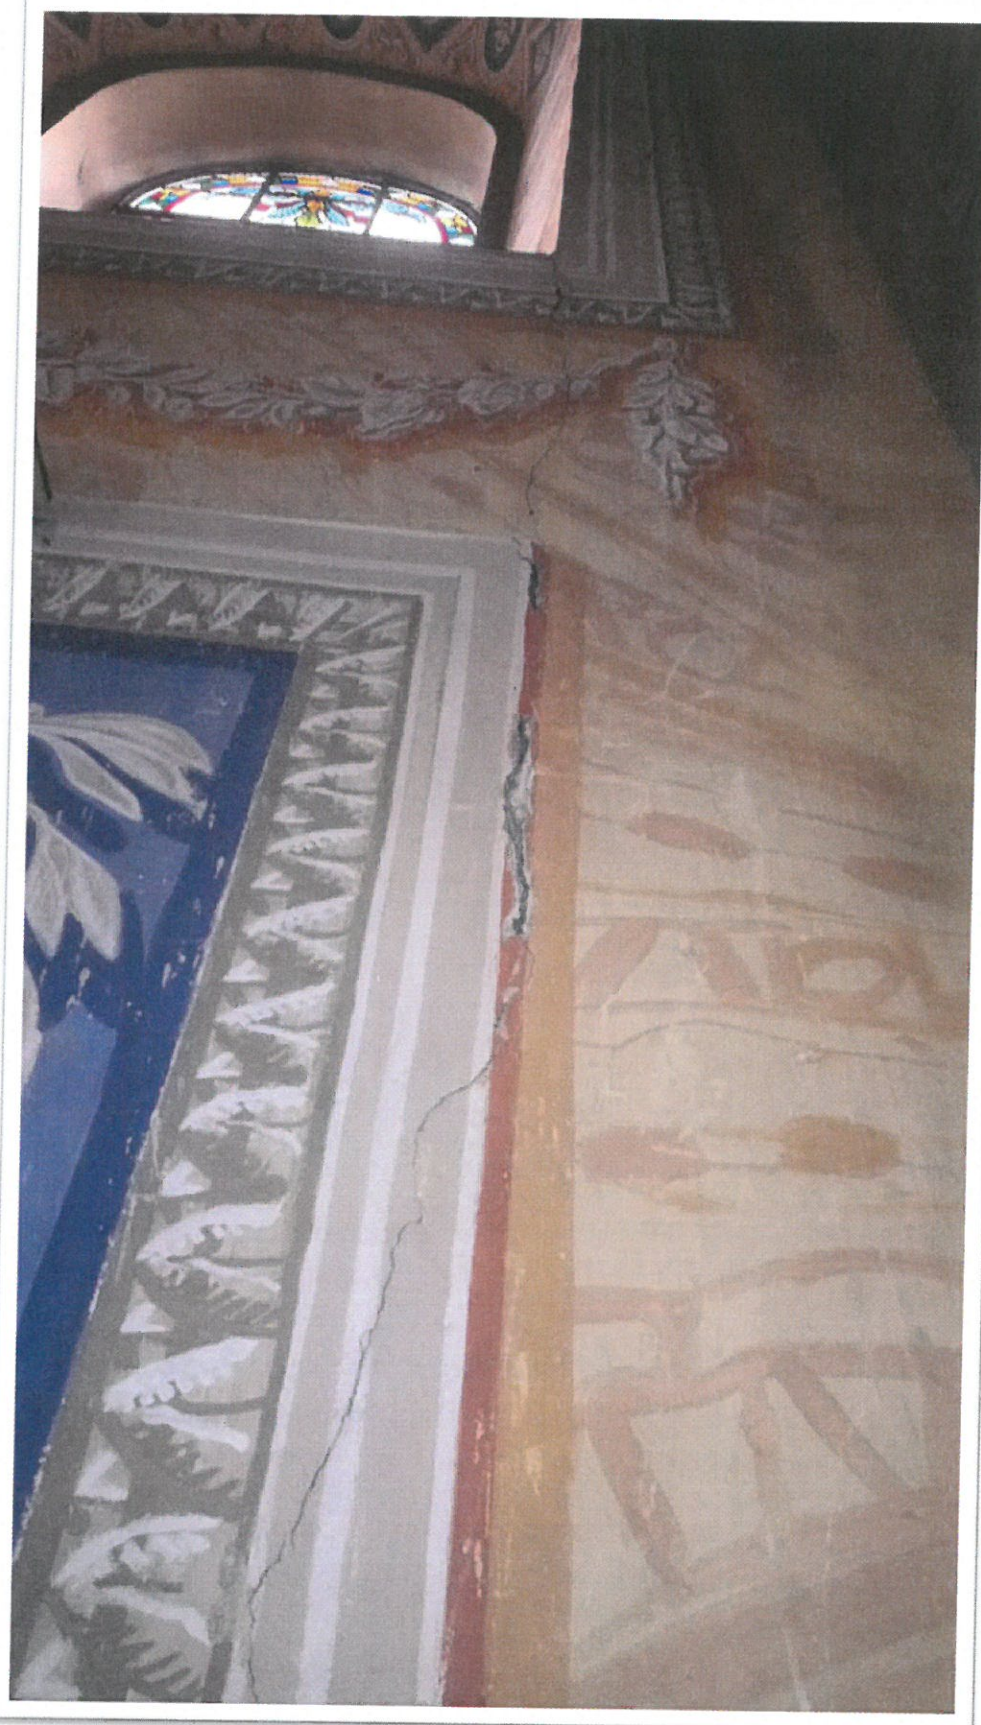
Pęknięcie muru i uszkodzenia tynków wewnętrznych.
